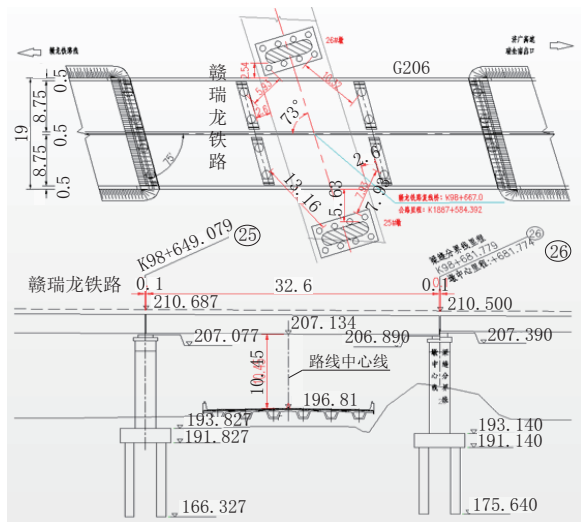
下穿赣瑞龙铁路平面、立面图(单位:m)
